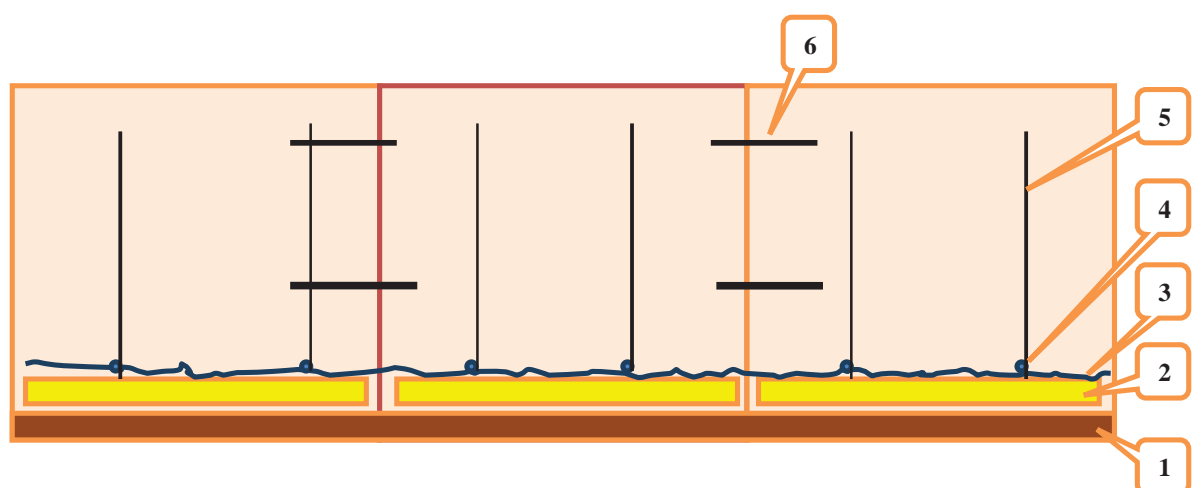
Искусственная потолочина с несущей арматурой: 1 – породная подушка; 2 – лежень; 3 – сетка; 4 – горизонтальные анкеры; 5 – вертикальные анкеры; 6 – железобетонные анкеры
